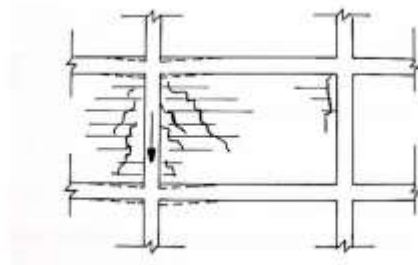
Fissuração de paredes divisórias causada pelo assentamento diferencial das fundações (estrutura reticulada de betão armado apoiada em sapatas isoladas). Sousa e Sousa (2014).
